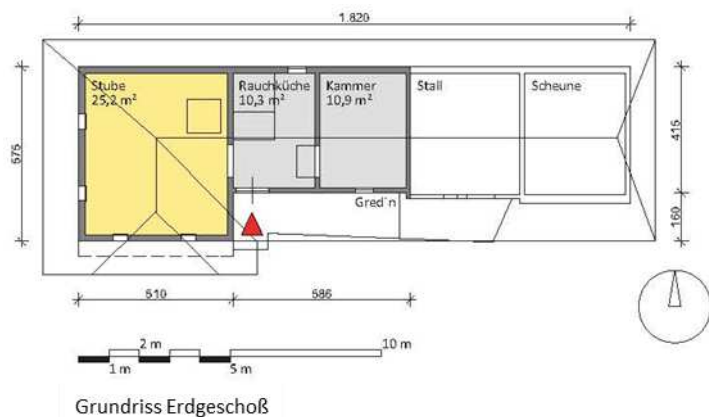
Grundrissdarstellung des Wohngeschoßes
